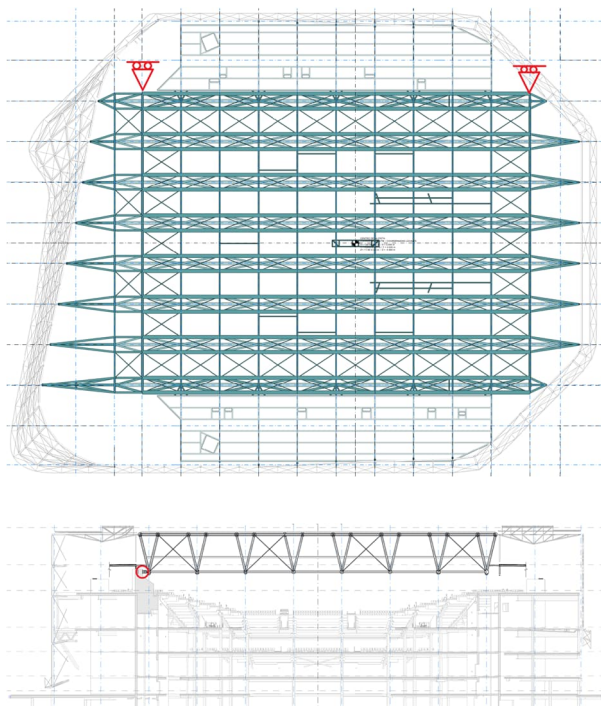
Planta de la cubierta y sección transversal por apoyos. Restricción lateral
